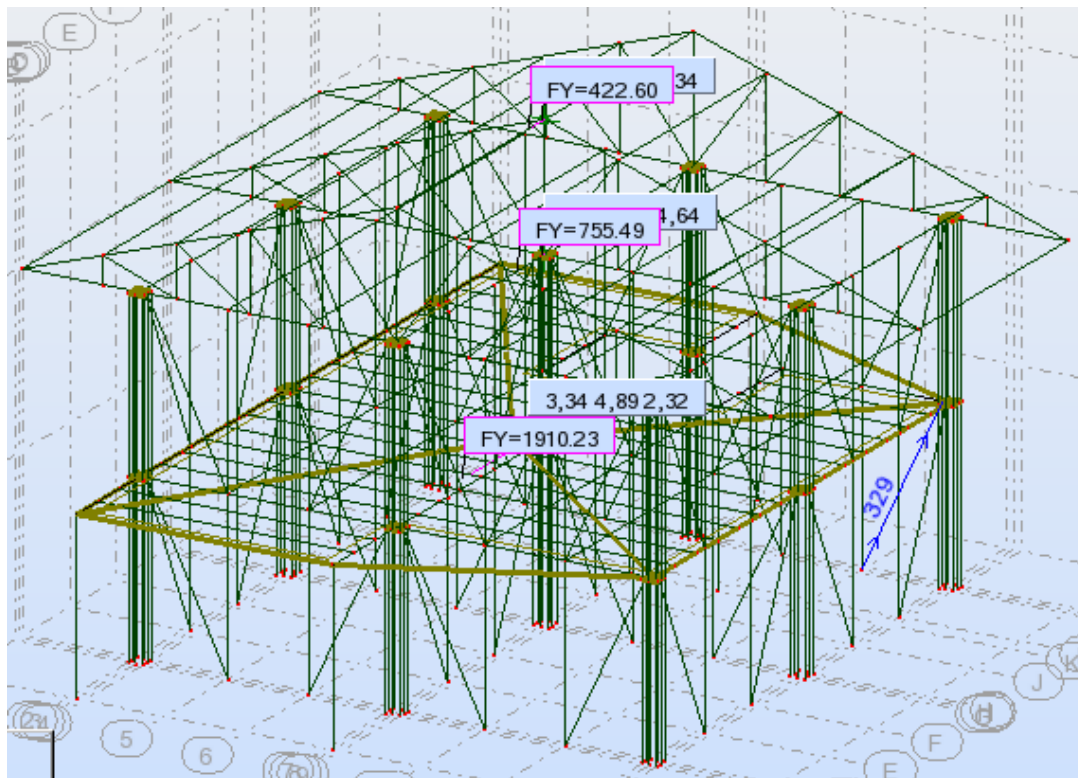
Aplicación de fuerzas basales (sentido y) en el centro de gravedad de las losas de la vivienda.
